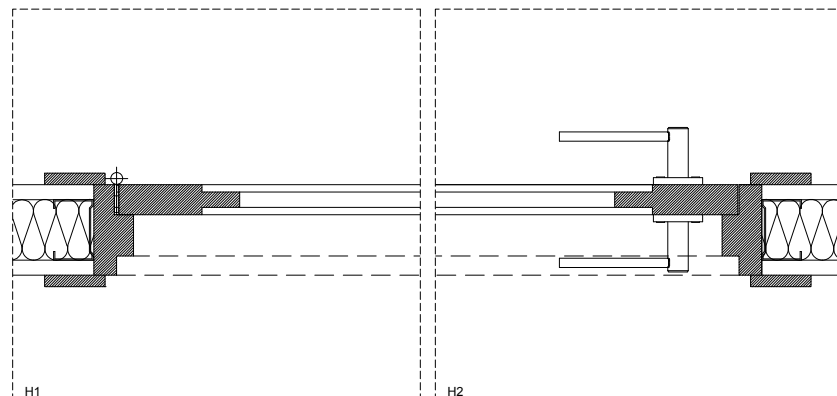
V1 | Proposta | Planta | Escala 1.10
